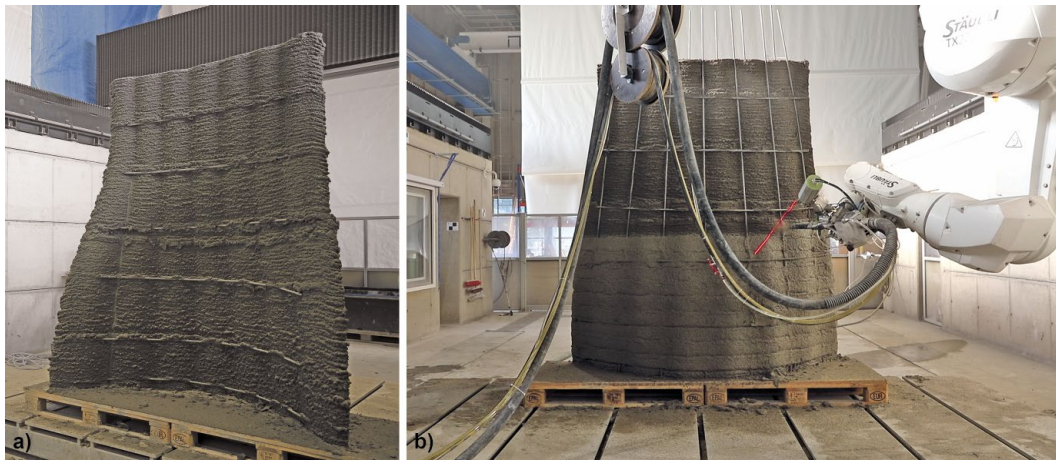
a) Gekrümmte Betonwand vor Einfädeln der Längsbewehrung, b) Second Layer 3-D Printing nach Einfädeln der Längsbewehrung
